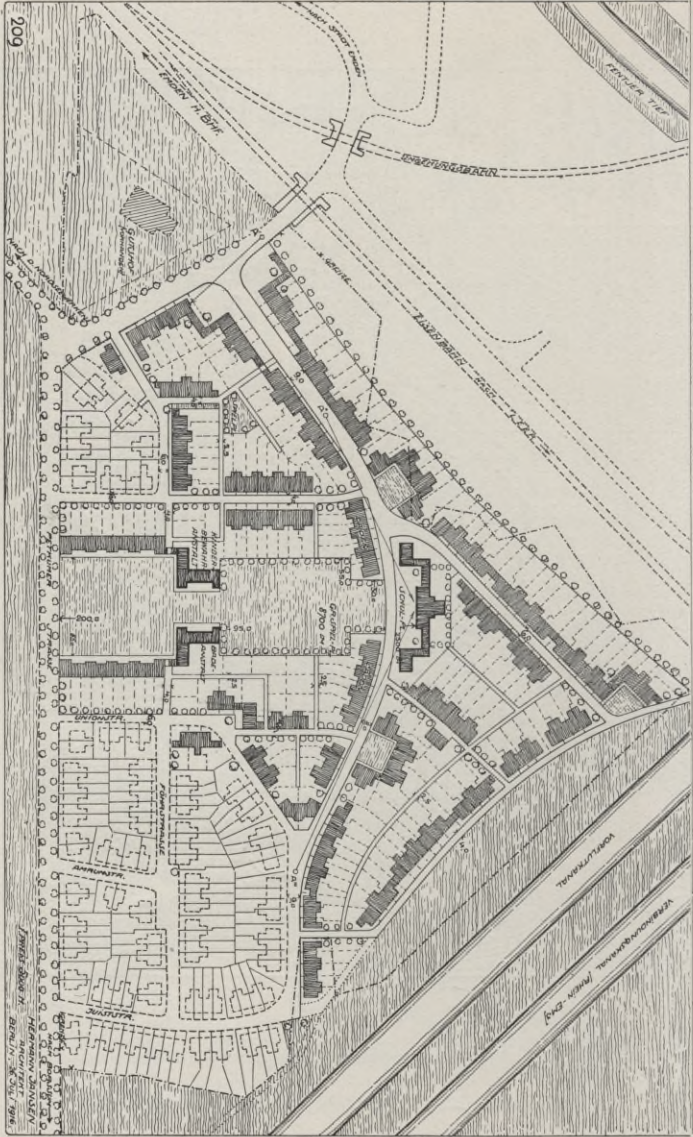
Plan der Gartenstadt Leipzig-Marienbrunn (Baurat Strobel).
